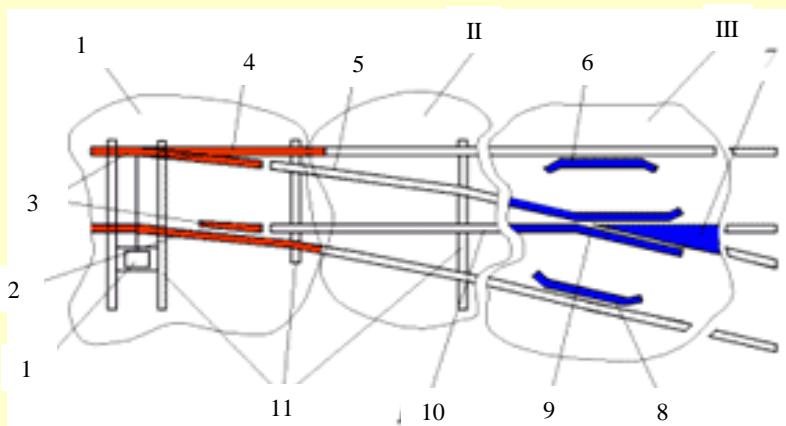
Схема стрелочного перевода: I – стрелка: 1 – переводной механизм; 2, 4 – рамные рельсы; 3 – острия; II – соединительные пути (5 – соединительные пути); III – крестовинная часть: 6, 8 – контррельсы; 7 – крестовина; 9 – усовики; 10 – соединительная прямая; 11 – переводные брусья
